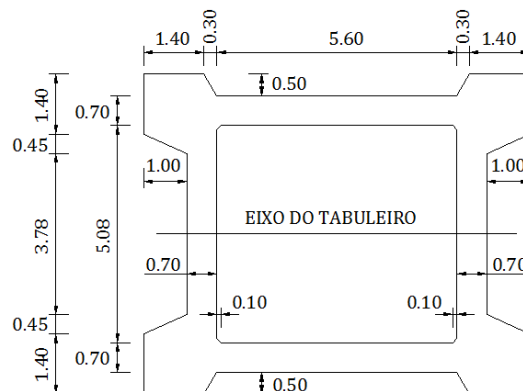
Secção transversal do pilar (caso de estudo 5)
